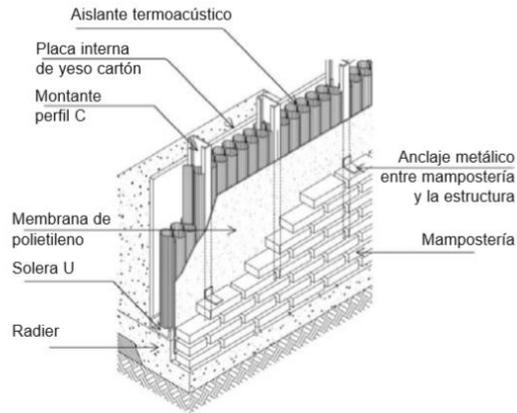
Diseño esquemático de cerramiento de mampostería de paneles en LSF.
